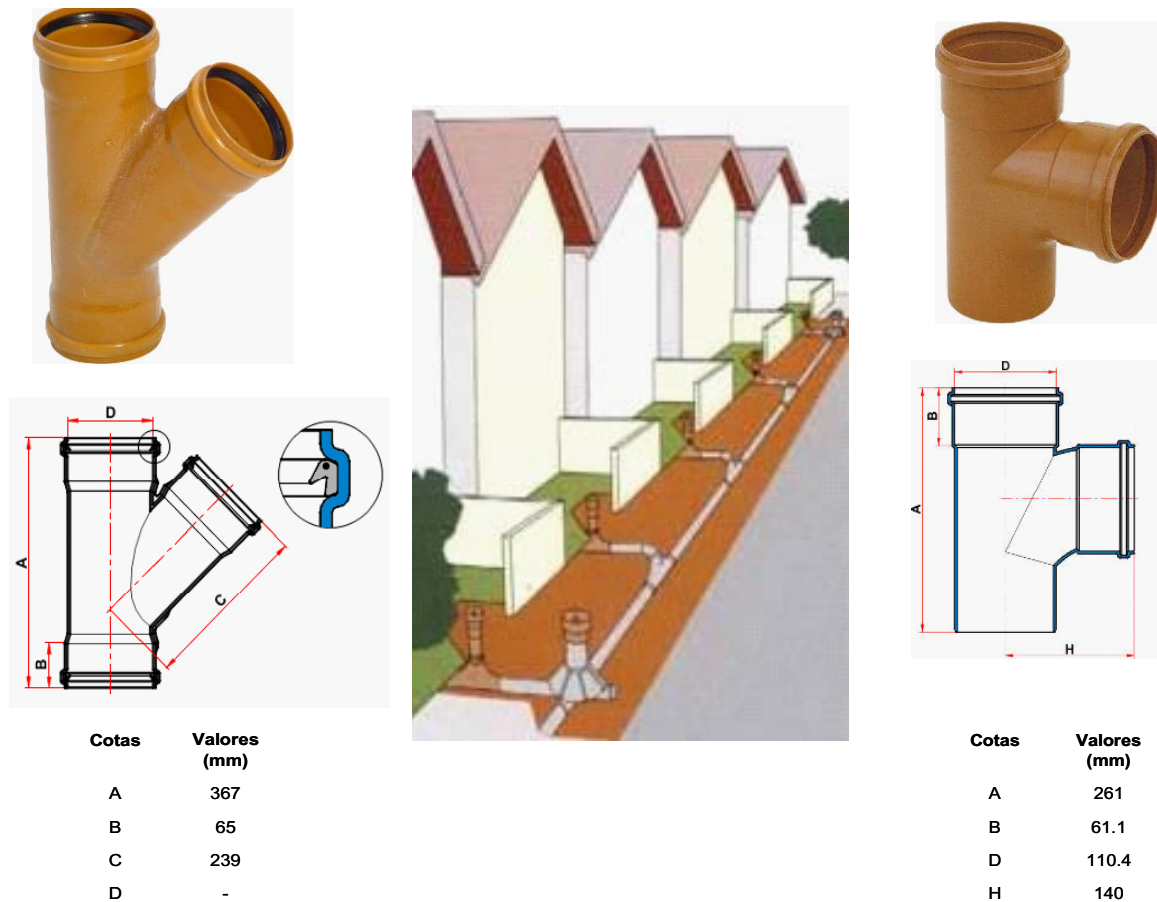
Accesorios de conexión directa de PVC tipo “T” o tipo “Y”
